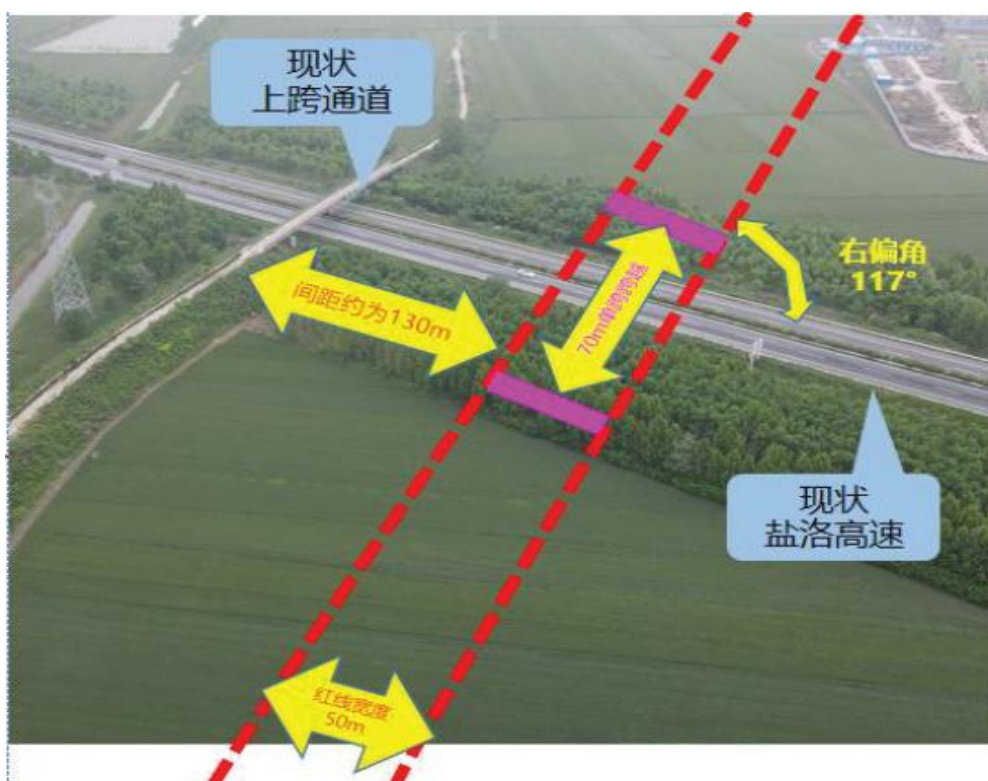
主线跨盐洛高速段主桥现场桥址平面图
